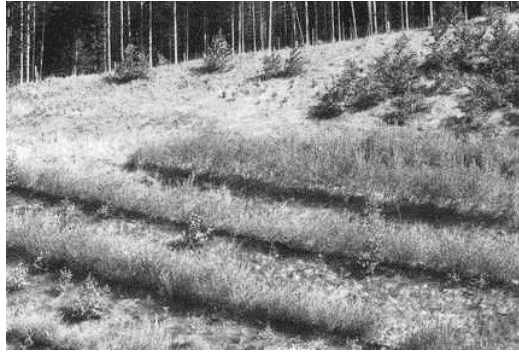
Construcción de lechos de ramaje en fajas longitudinales.
